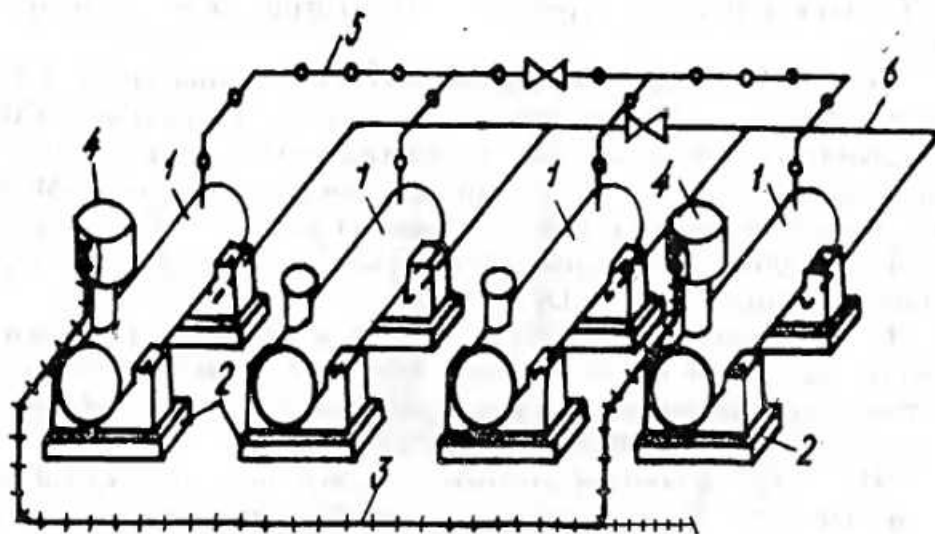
Схема обв'язування трубопроводами підземної резервуарної установки: 1 - резервуар; 2 - фундамент; 3 - підземний газопровід до споживачів; 4 - редуційна головка; 5 - трубопровід парової фази; 6 - трубопровід рідкої фази
